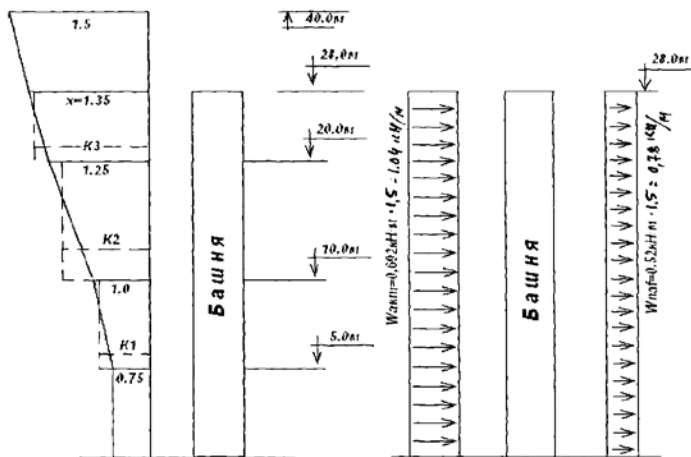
Схема передачи ветровой нагрузки на водонапорную башню
